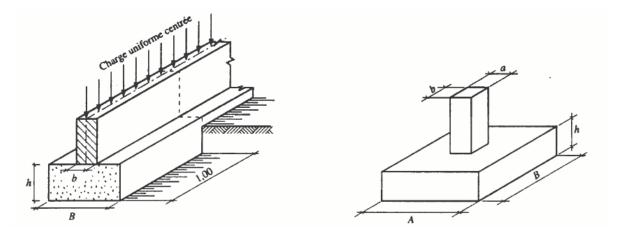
Schéma de la semelle filante sous poteaux.
